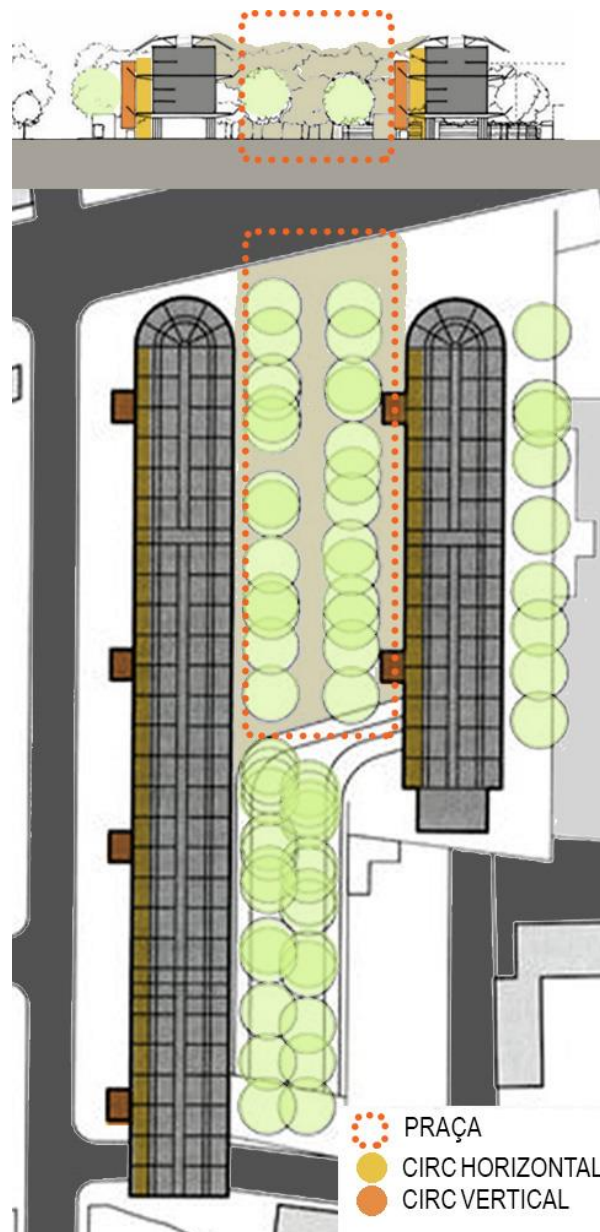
Implantação e Corte do Conjunto Habitacional Nemausus. Espaços de passagem e convívio em evidência
